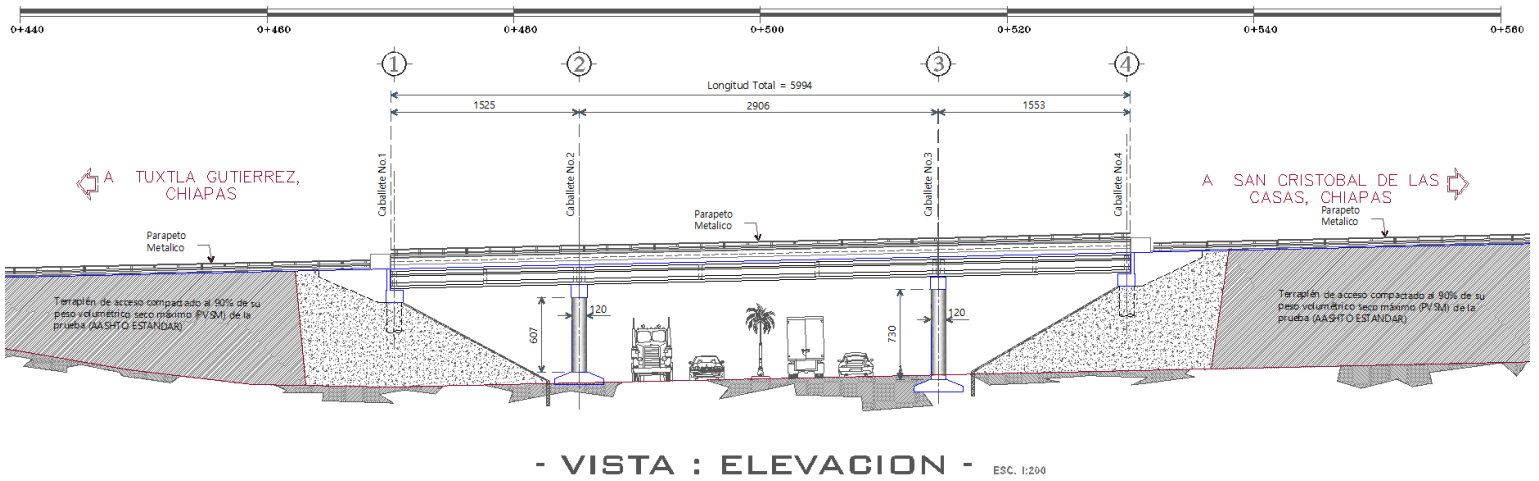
Vista en elevación del puente ubicado en el kilómetro 000+500, Tuxtla Gutiérrez – San Cristóbal de las Casas.
